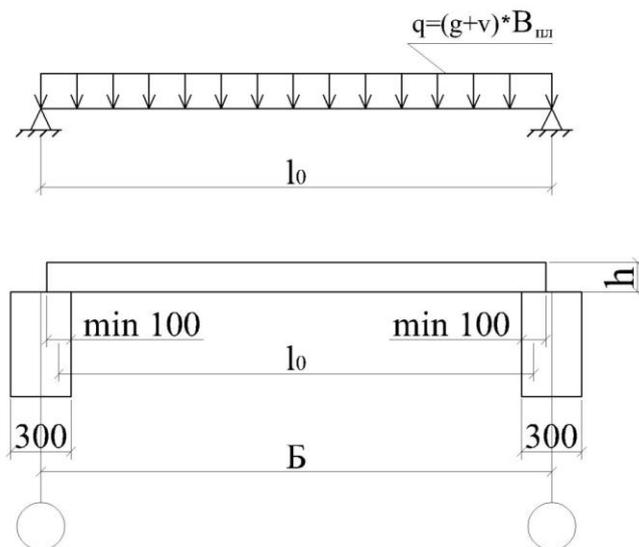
Расчетная схема и схема опирания панели перекрытия
